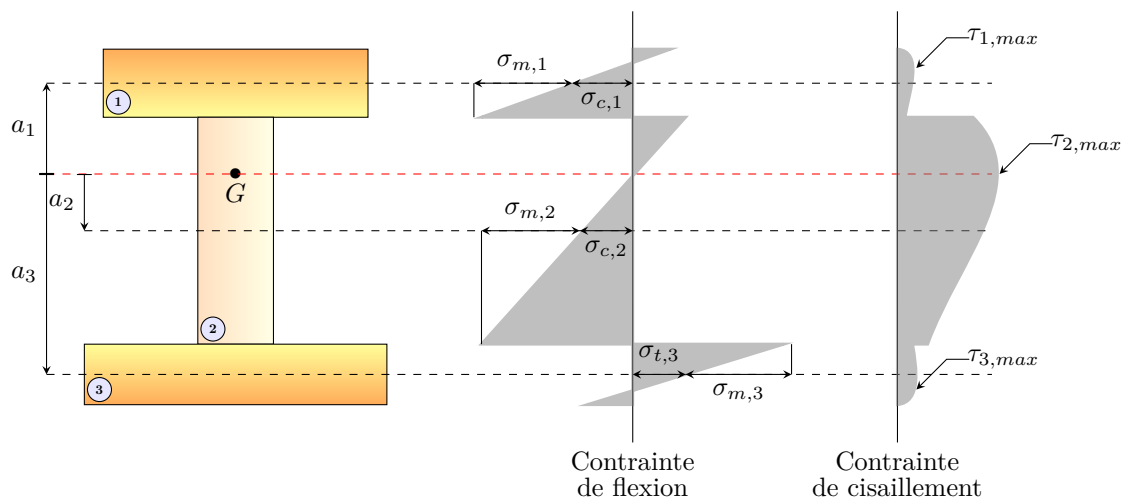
Contraintes dans la section de la poutre reconstituée
